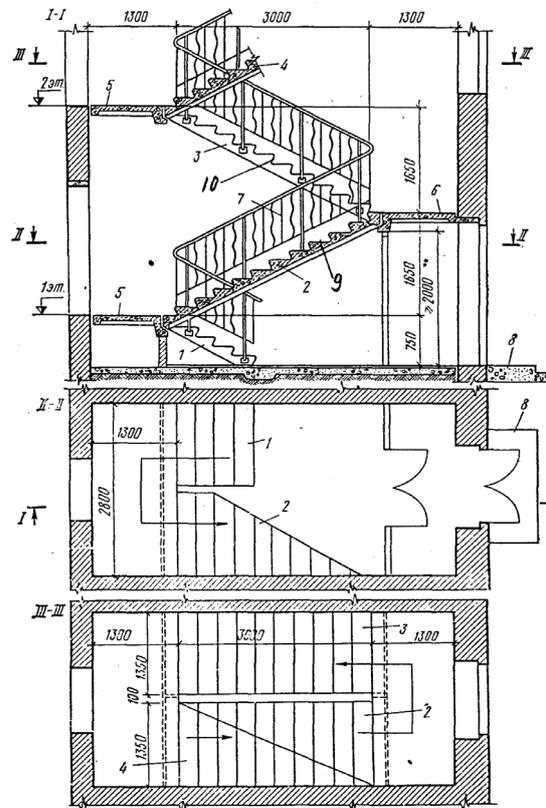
Поперечный разрез и поэтажные планы двухмаршевой лестницы из сборных железобетонных маршей и площадок
